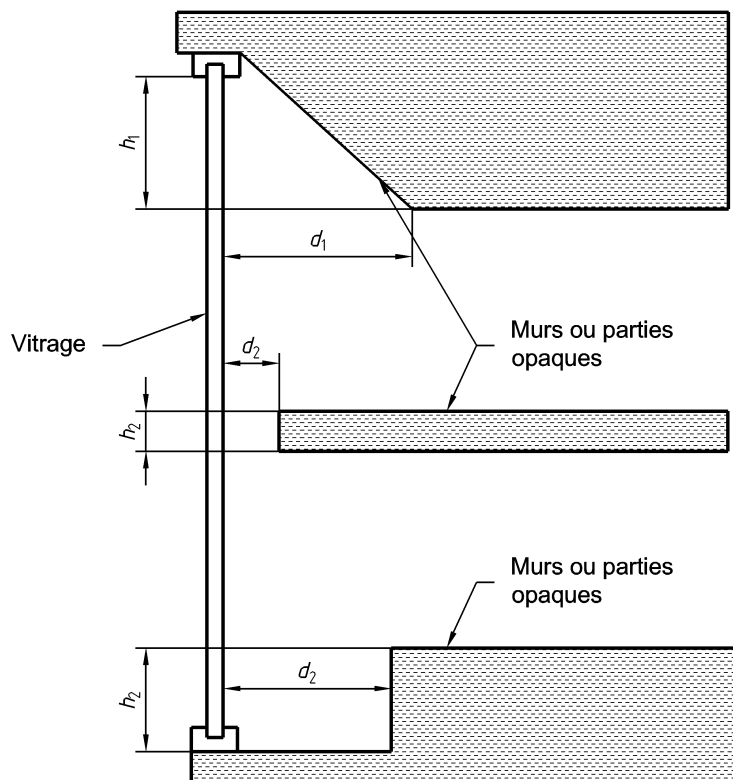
Coupe verticale d'un vitrage devant une paroi opaque
